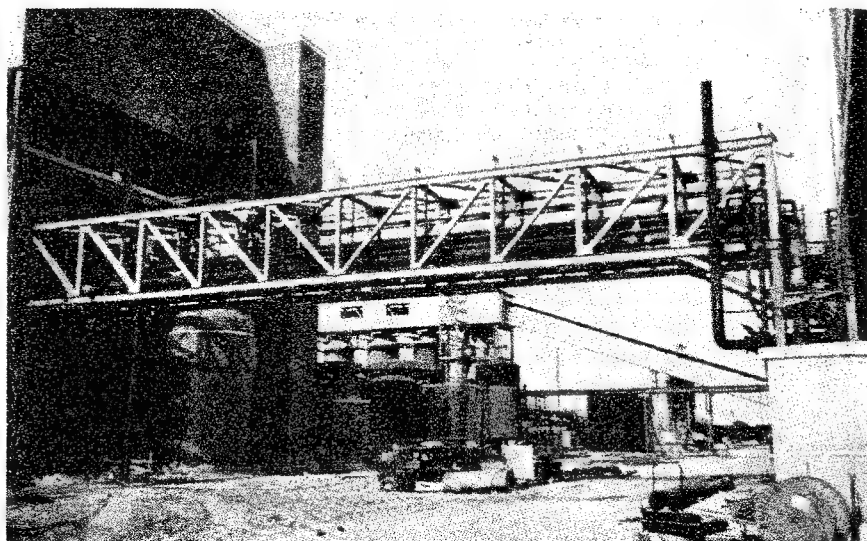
Vista exterior del puente soporte de las tuberías.
